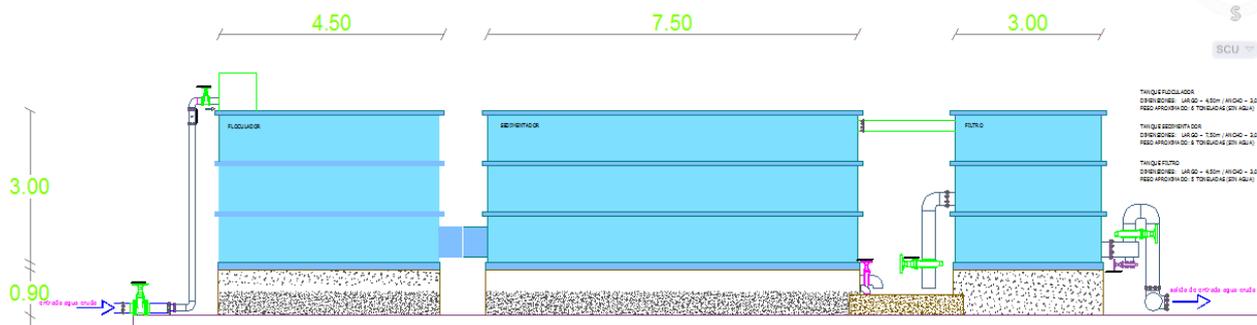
Vista en corte, planta de tratamiento modular 2D
